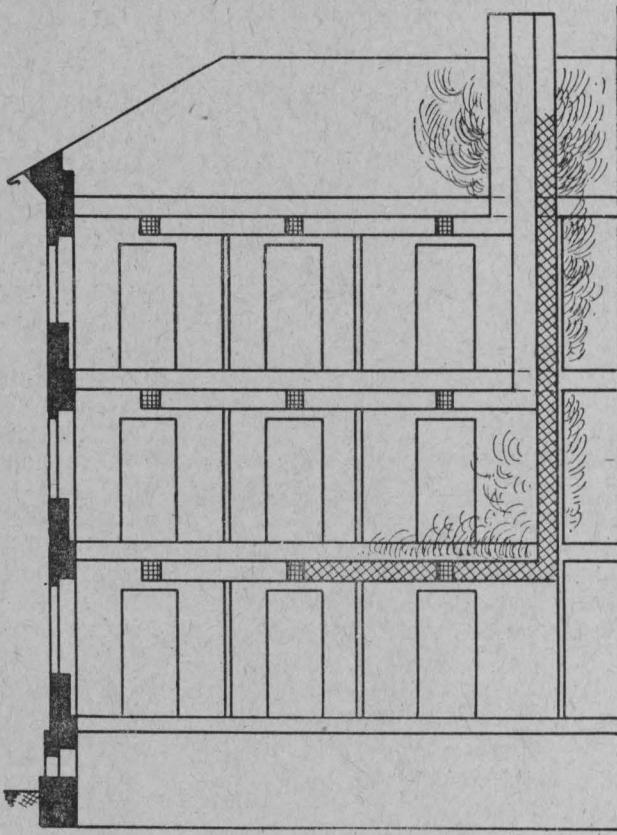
Расположение вентиляционных каналов в этажах зданий.
